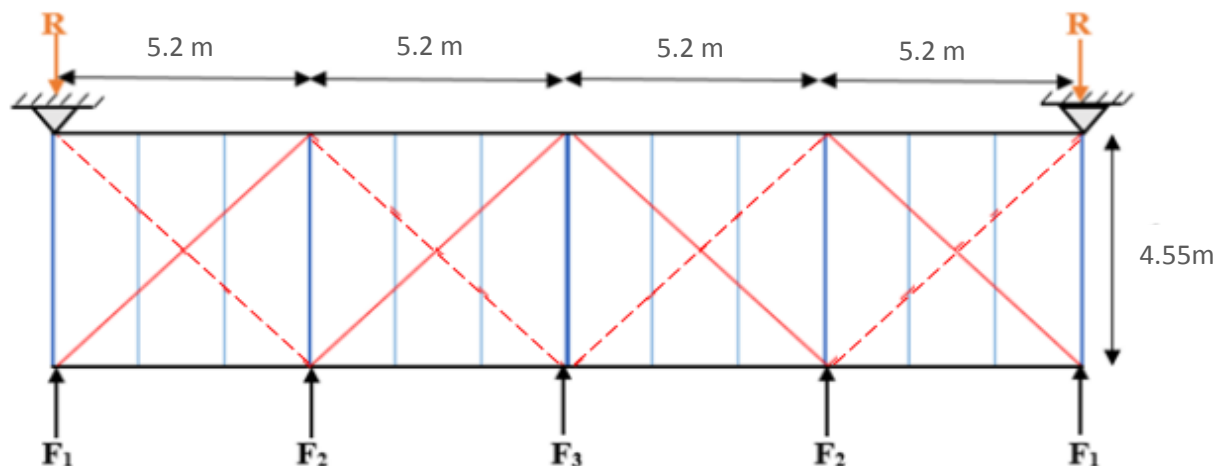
Schéma statique de la poutre au vent (effet de traction).
